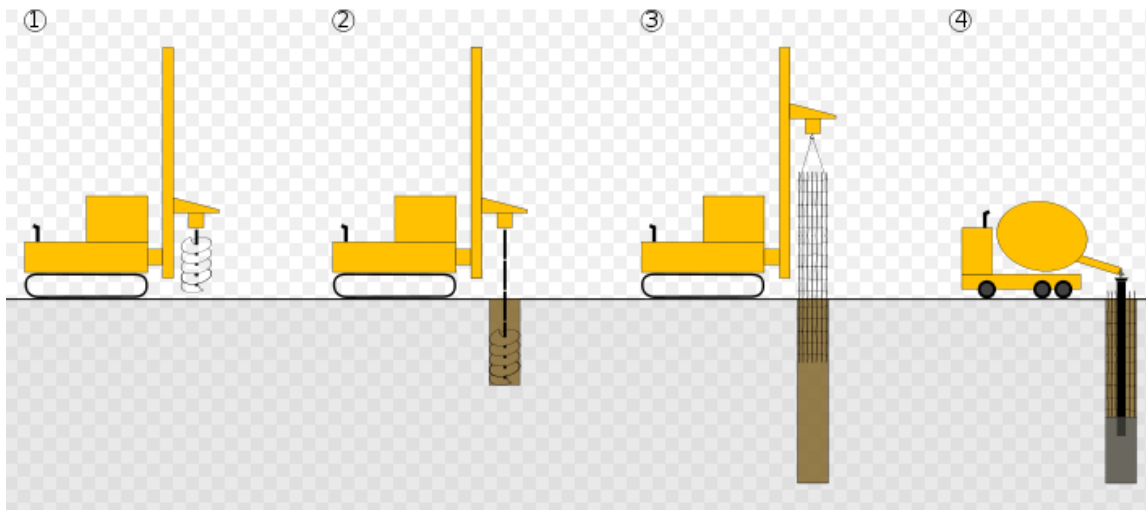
Corte transversal del proceso de barrenado, colocación de acero y colado de micropilote.
